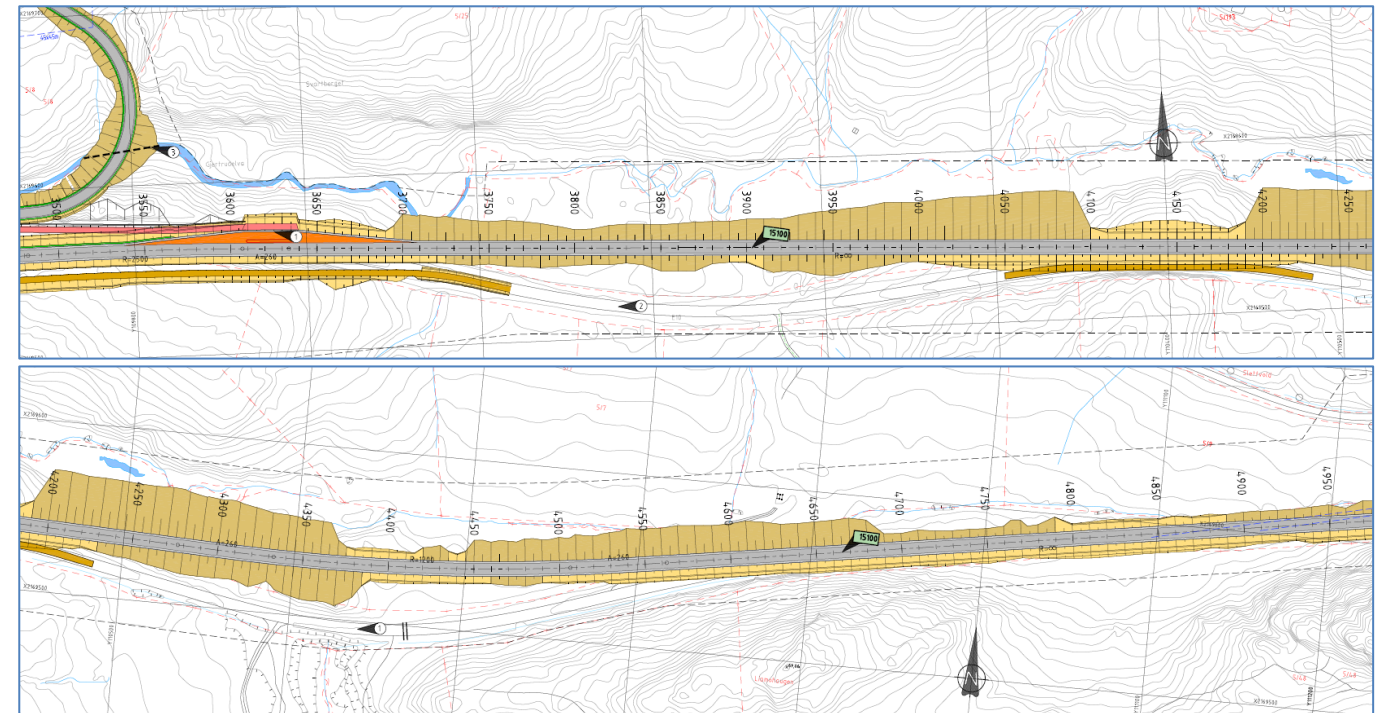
Kryssområde Liakollveien, kulvert under planlagt E10 til Kvitforsveien.
